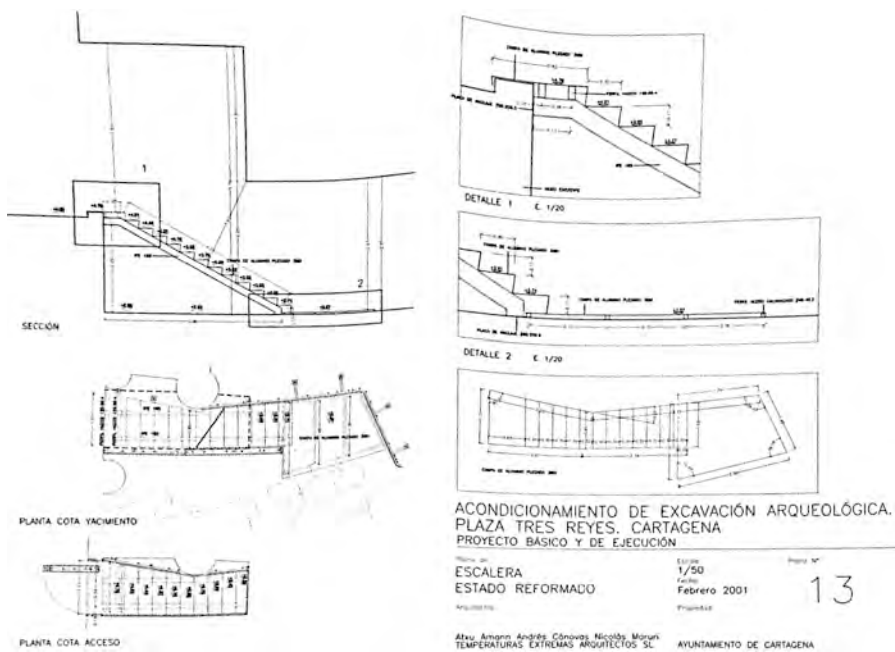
Planimetría con plantas y secciones de la escalera que permite el acceso al *decumanus*. (Amann *et alii* 2001)
